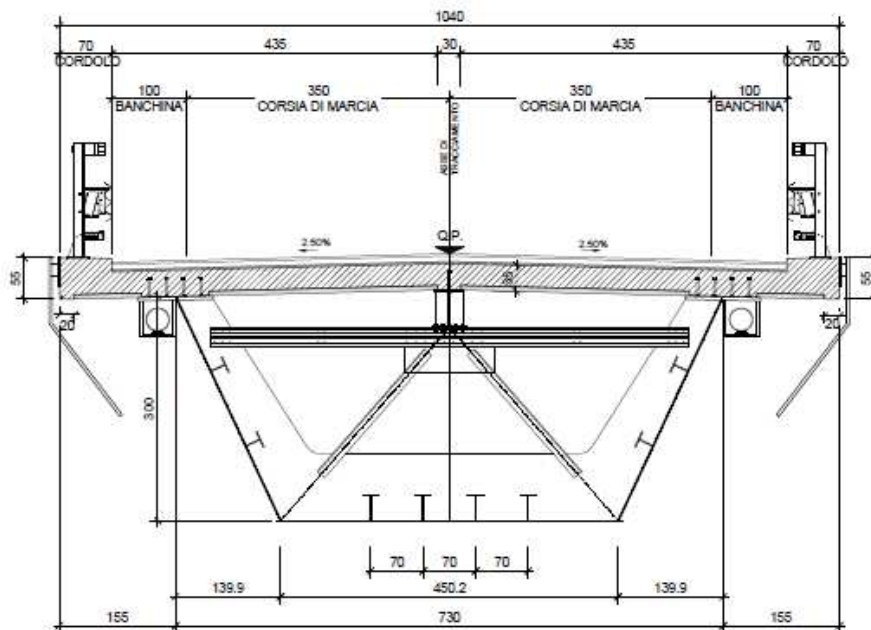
Sezione impalcato Ponte sul Collettore Burana
